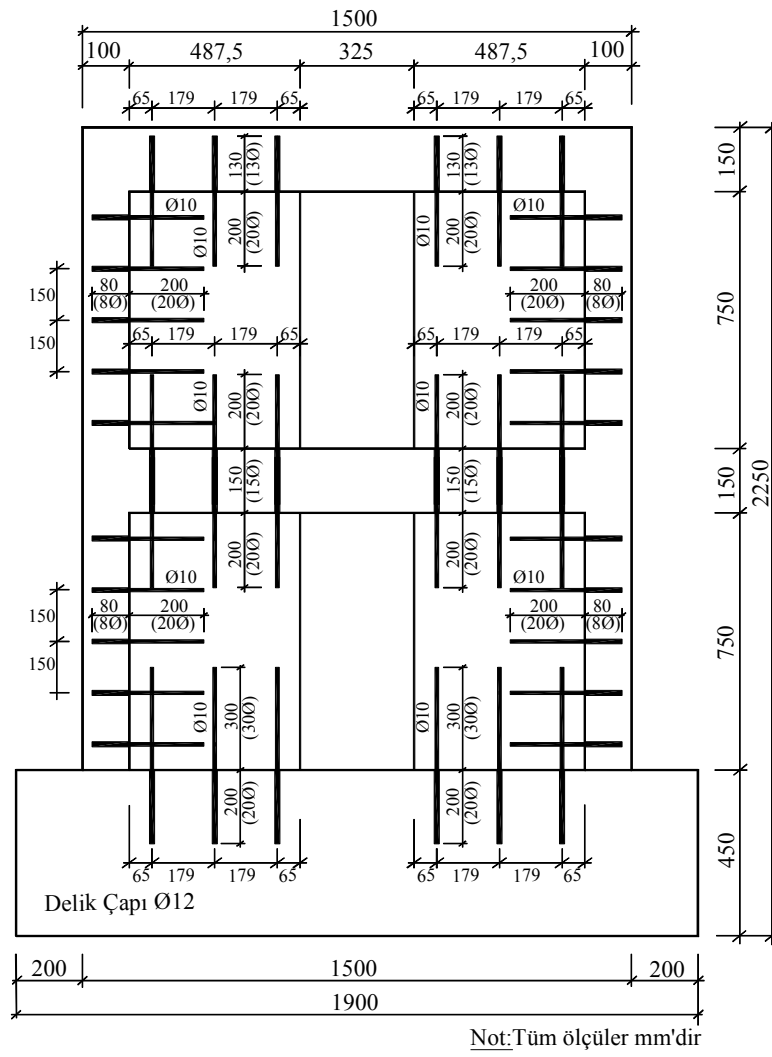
Deney Elemanı-7'nin donatı detayı
